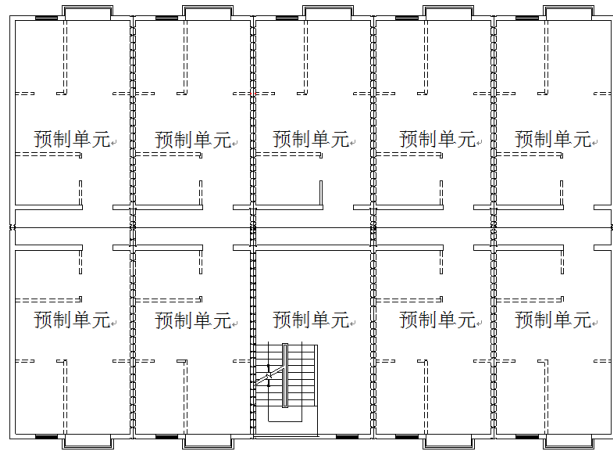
模块化全装配预制混凝土住宅结构体系平面拼接示意图
